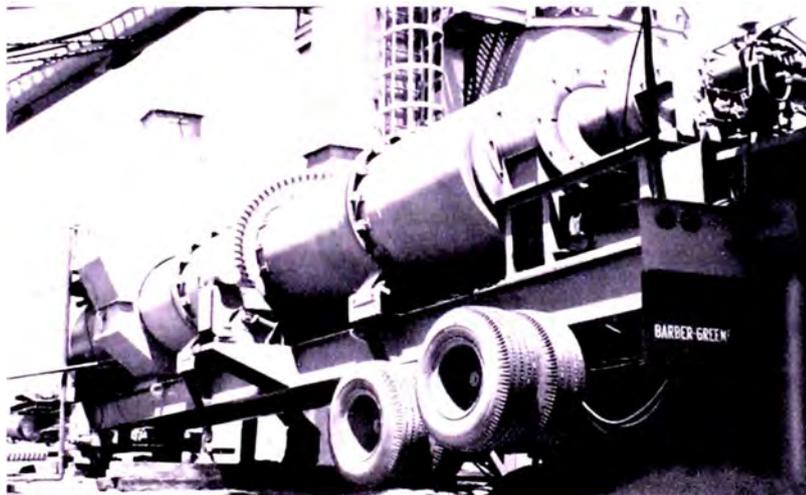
Planta de asfalto Termo-Mezcladora BARBER GREENE
